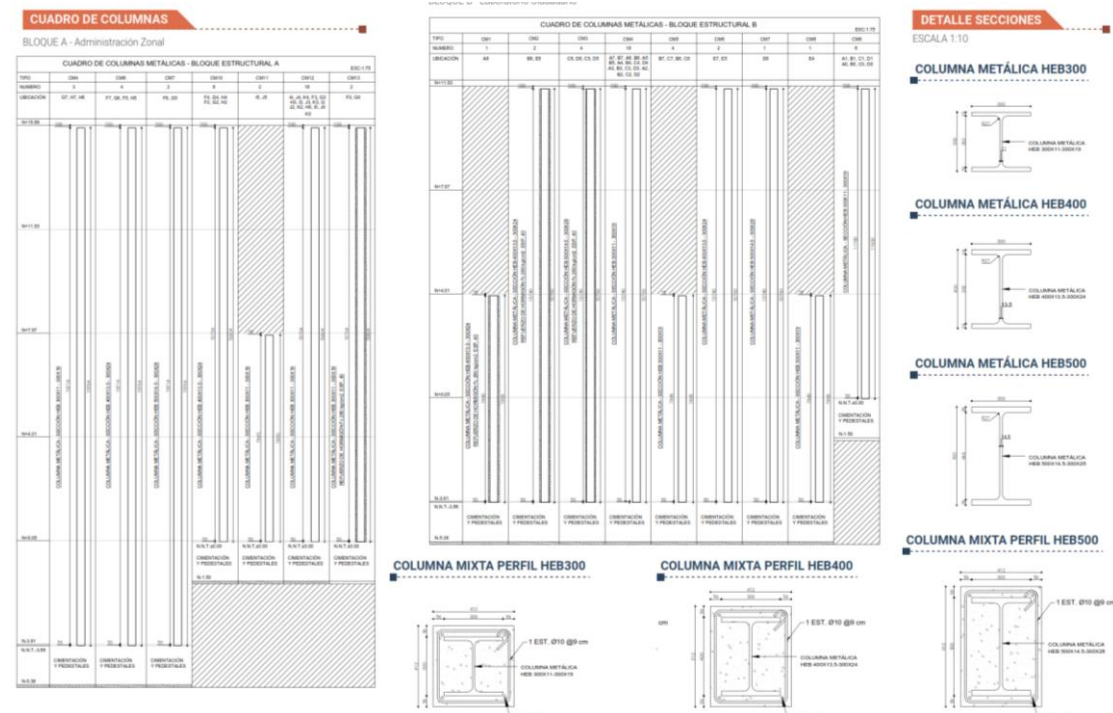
Cuadros de columnas y detalles de secciones (Gualavisí N., 2022)
